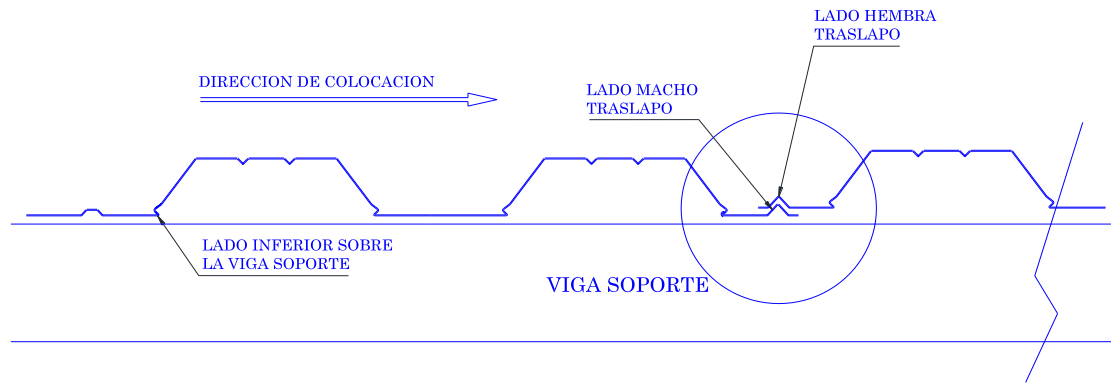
DETALLE DE TRASLAPO Y ANCLAJE DE LOSA METALDECK.
